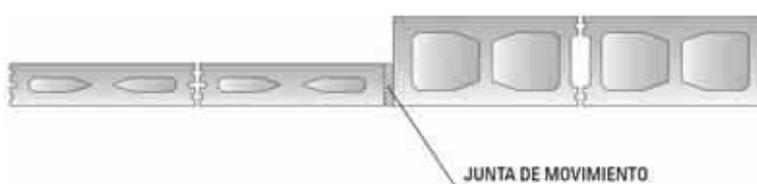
Junta de movimiento en cambio de sección de muro.
